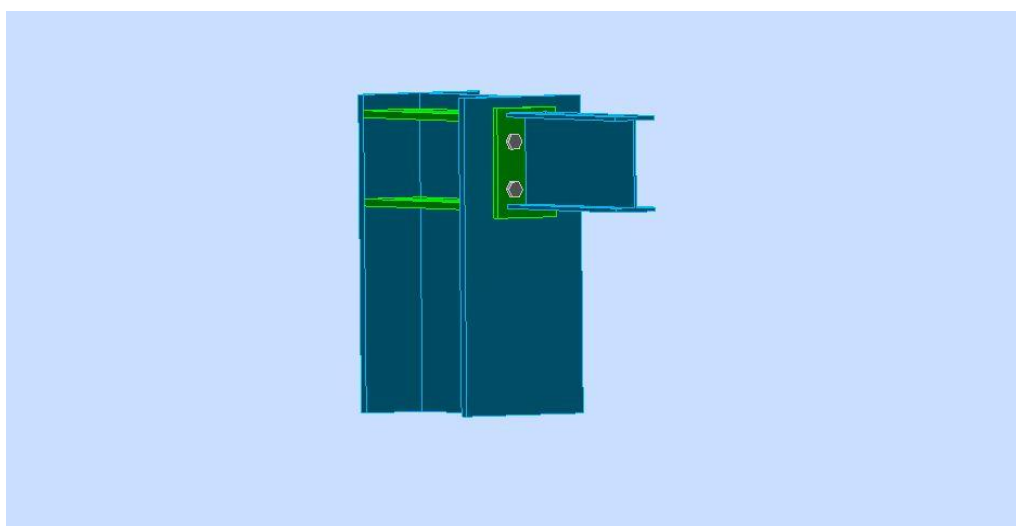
Vue 3D de l'assemblage poteau poutre secondaire.
